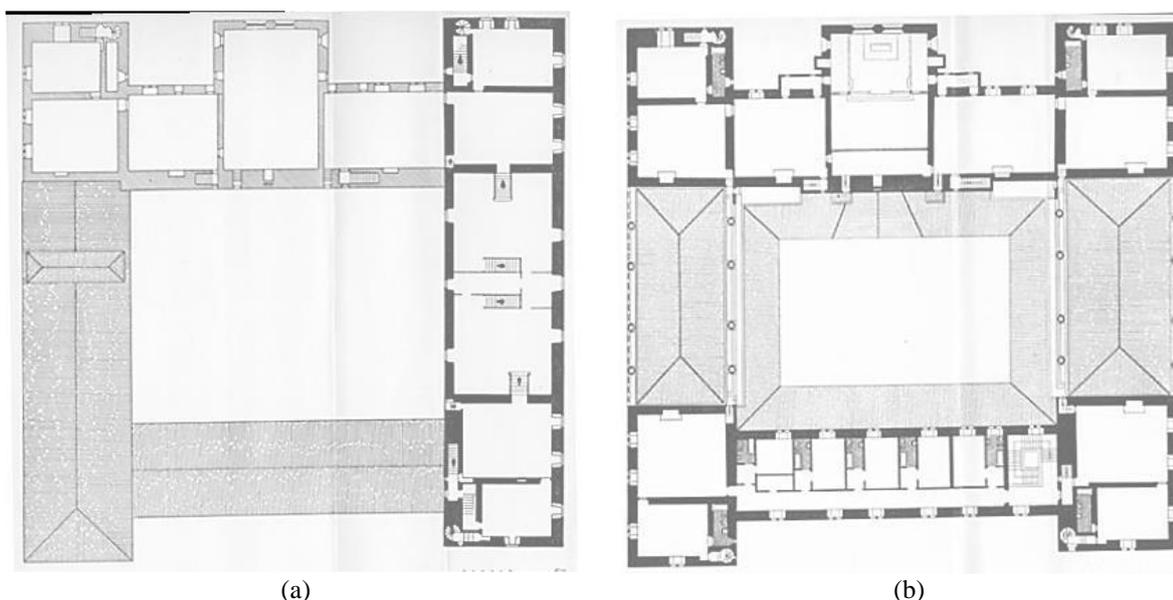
Planta segundo pavimento: (a) Antes do restauro; (b) Depois do restauro.
